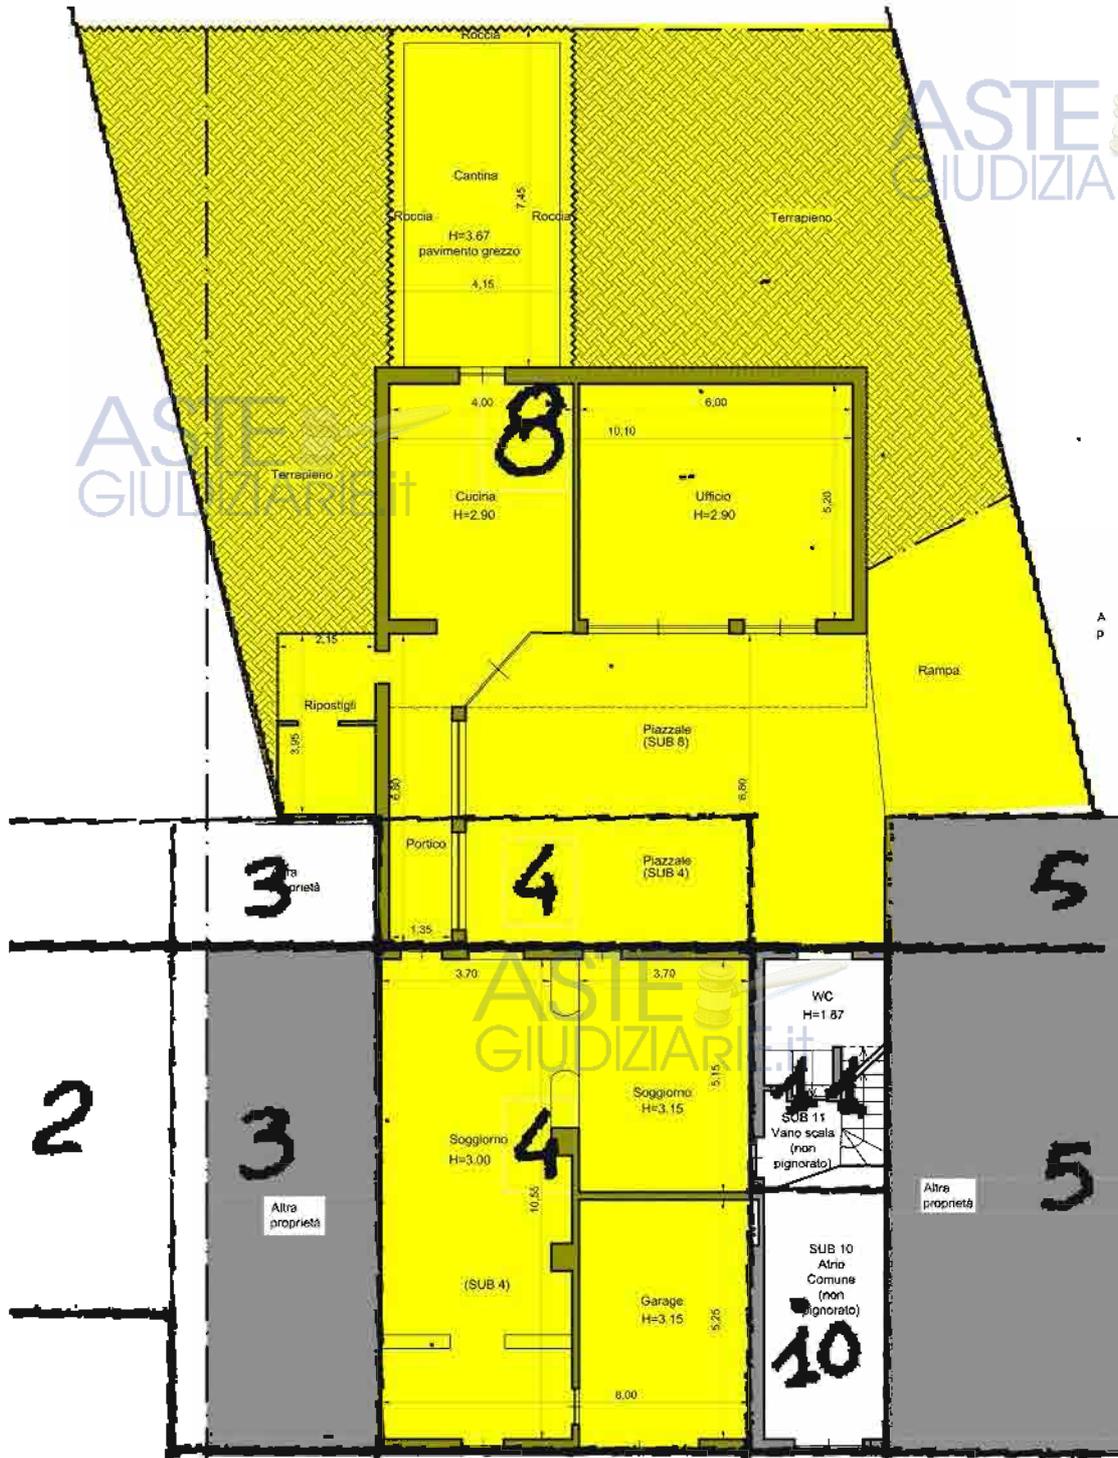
Sovrapposizione pianta stato di fatto piano terra con elaborato planimetrico. In giallo la parte pignorata
